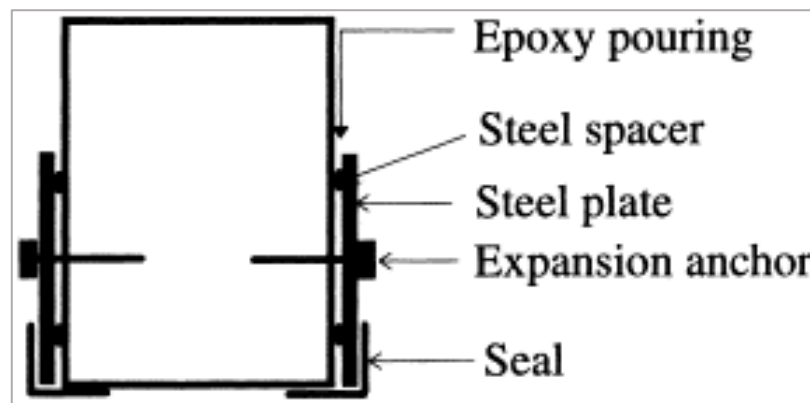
Refuerzo de una viga con pletinas de acero [40].
